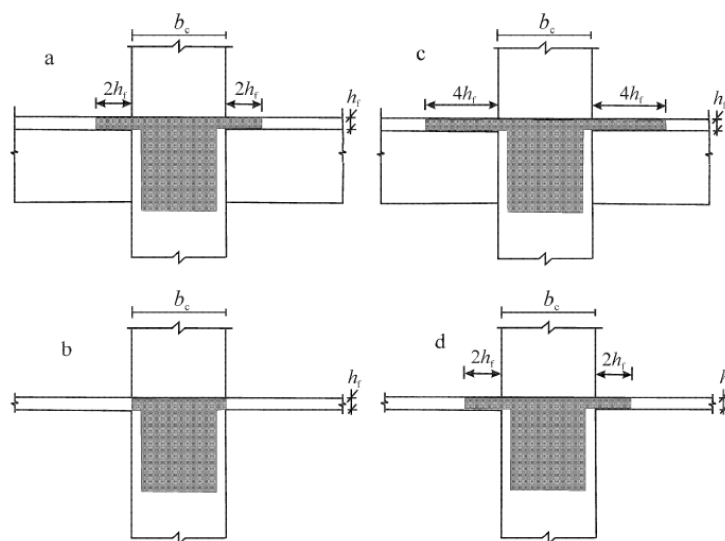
Largura efetiva para vigas ligadas a pilares exteriores (a e b) e interiores (c e d) [9].
